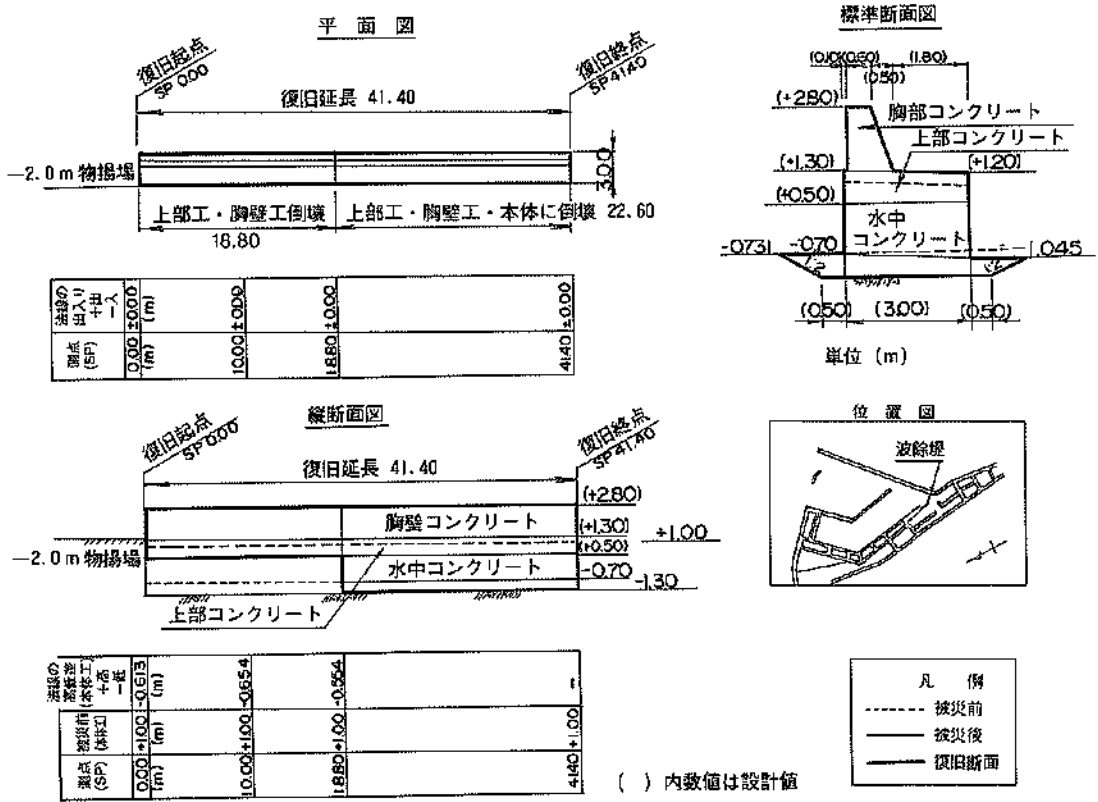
被災状況平面図・標準断面図 (青苗漁港、⑦船揚場(南))
